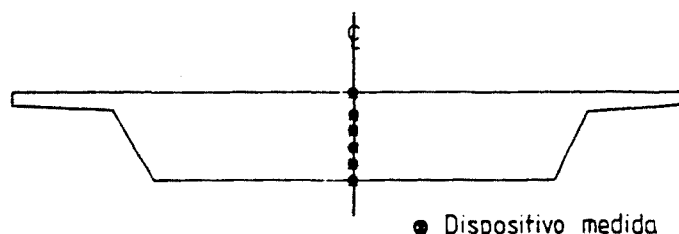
Instrumentación de puentes en losa maciza.
